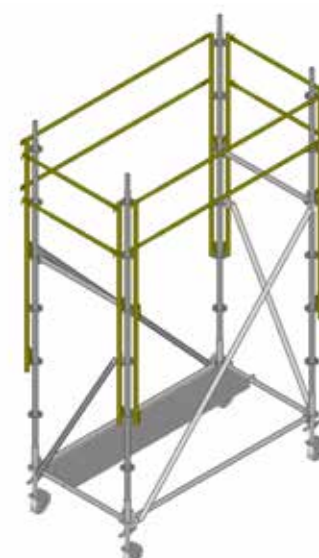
Démontage des planchers du niveau supérieur et du support d'échelle.
